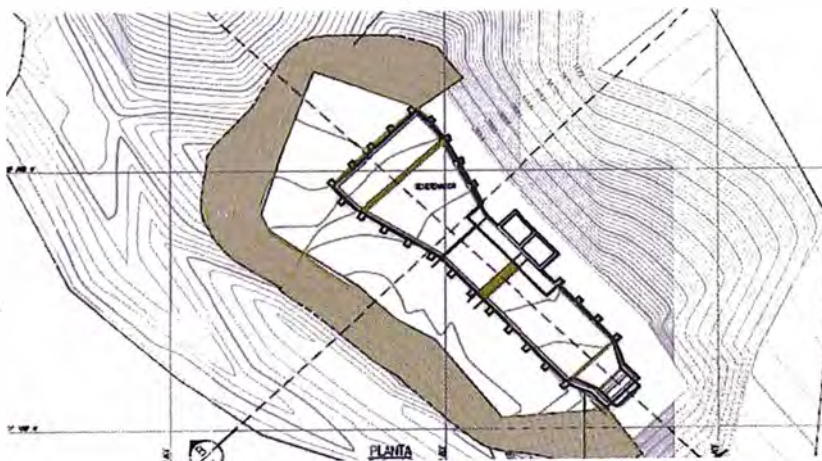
Vista en Planta Relleno Roca – Cemento en Desarenador
